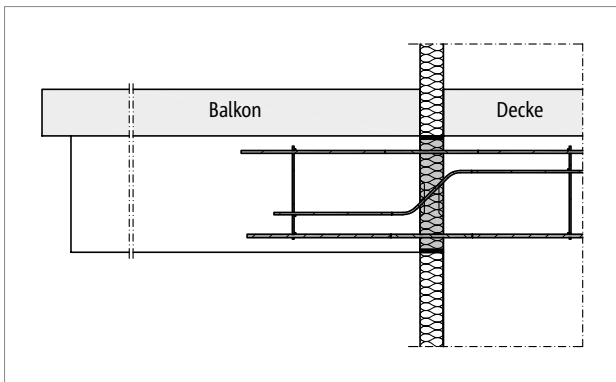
Schöck Isokorb® T Typ BP: Balkonkonstruktion mit frei auskragenden Unterzügen (Fertigteilbalkon)
